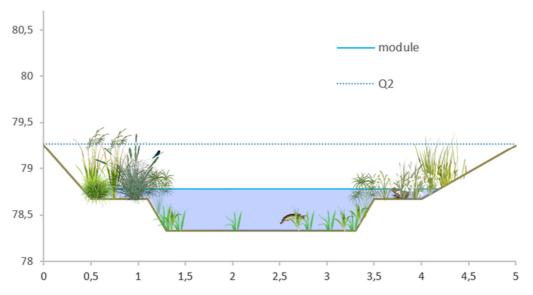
Profil en travers du bras gauche de continuité après travaux
